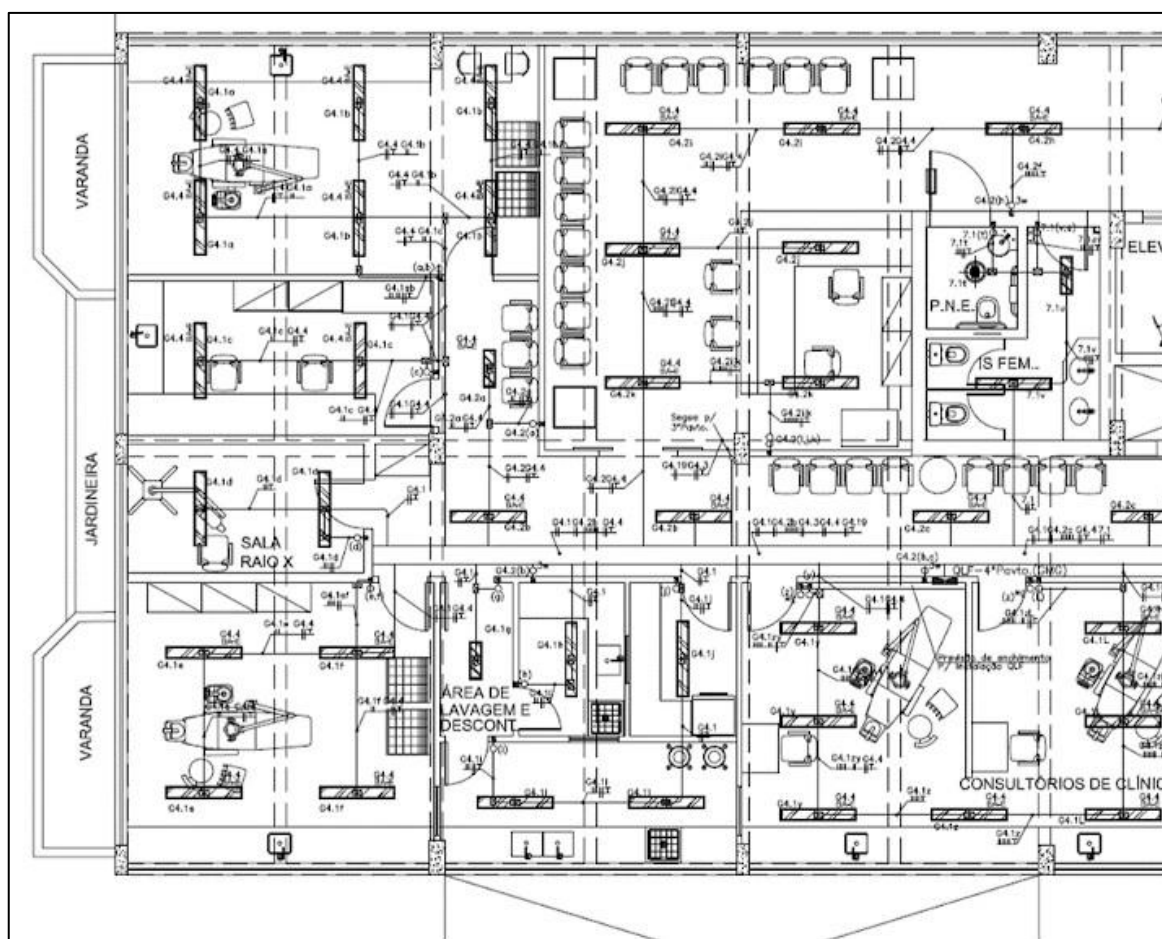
Planta 4º pavimento representação das vigas sem indicação de transposição.
